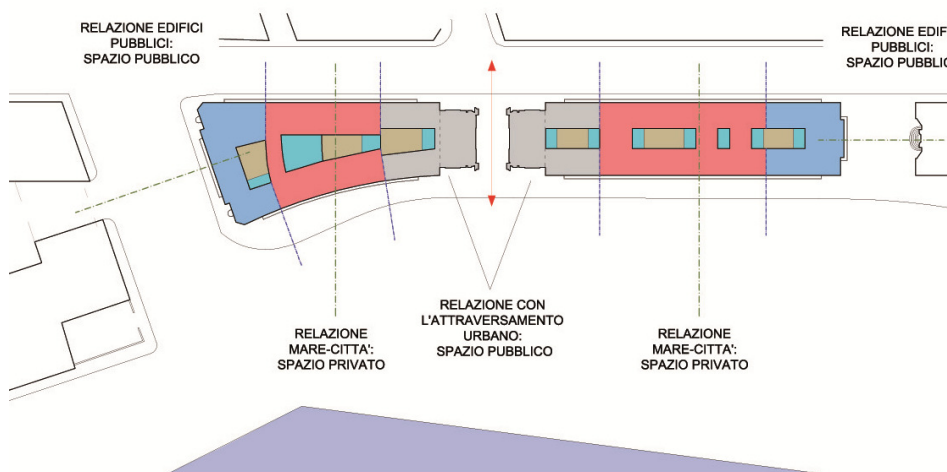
Schema di tripartizione della pianta secondo una distinzione tra spazio pubblico e privato e secondo un rapporto di simmetria con il prospetto
